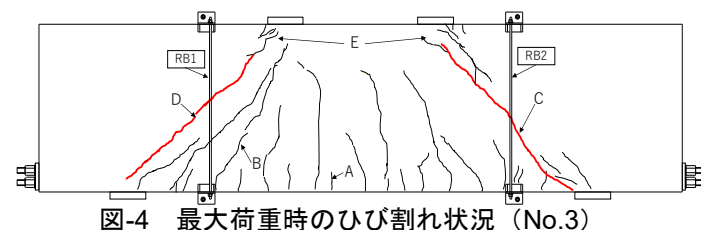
最大荷重時のひび割れ状況 (No.3)
